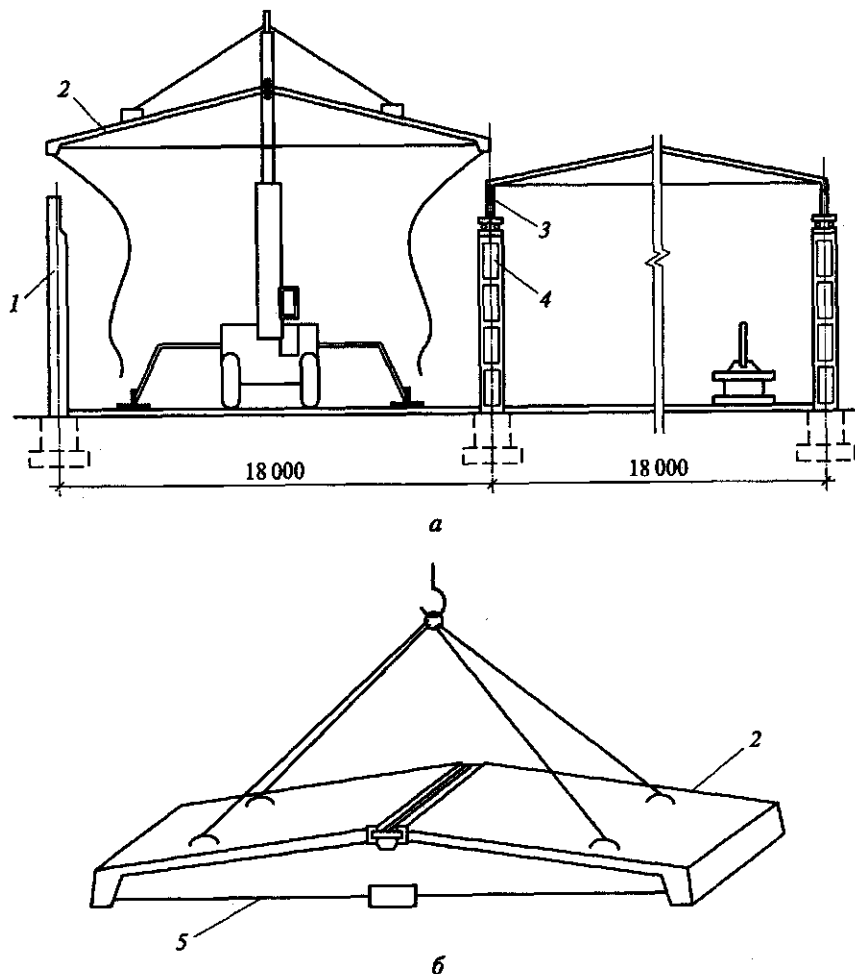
Возведение быстромонтируемых сельскохозяйственных зданий:
